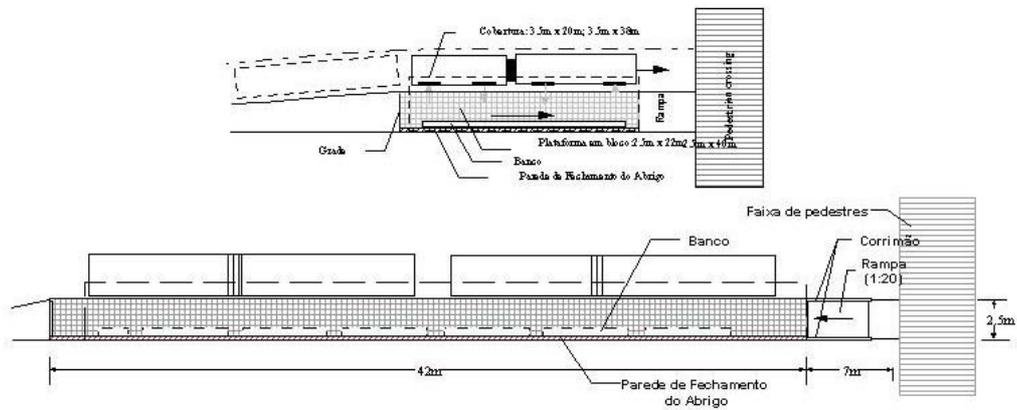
Planta de Ponto de Ônibus na Canaleta (sem escala)
